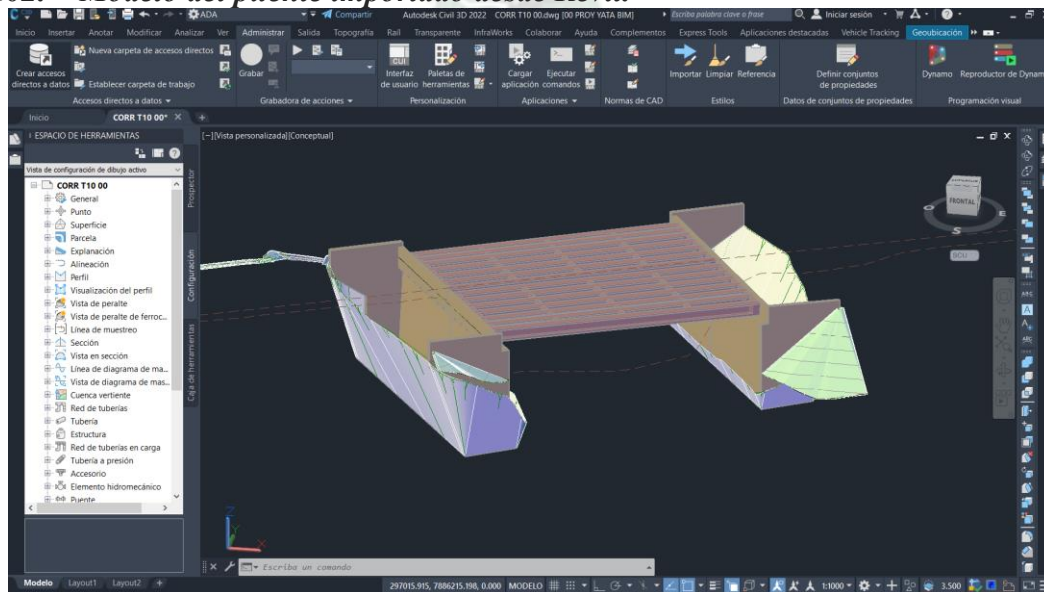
Emplazado de Barreras metálicas y Barreras de protección.
